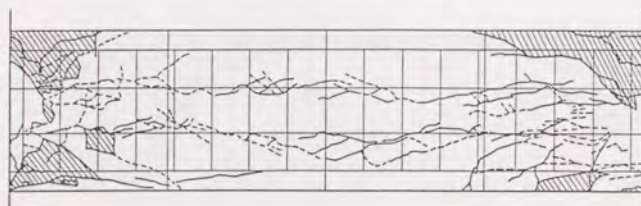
ひび割れ状況（試験体 B3）
